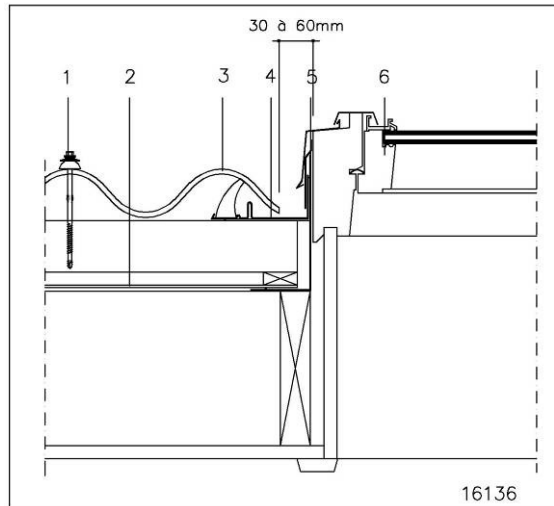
Installation d'une fenêtre de toit - finition latérale
